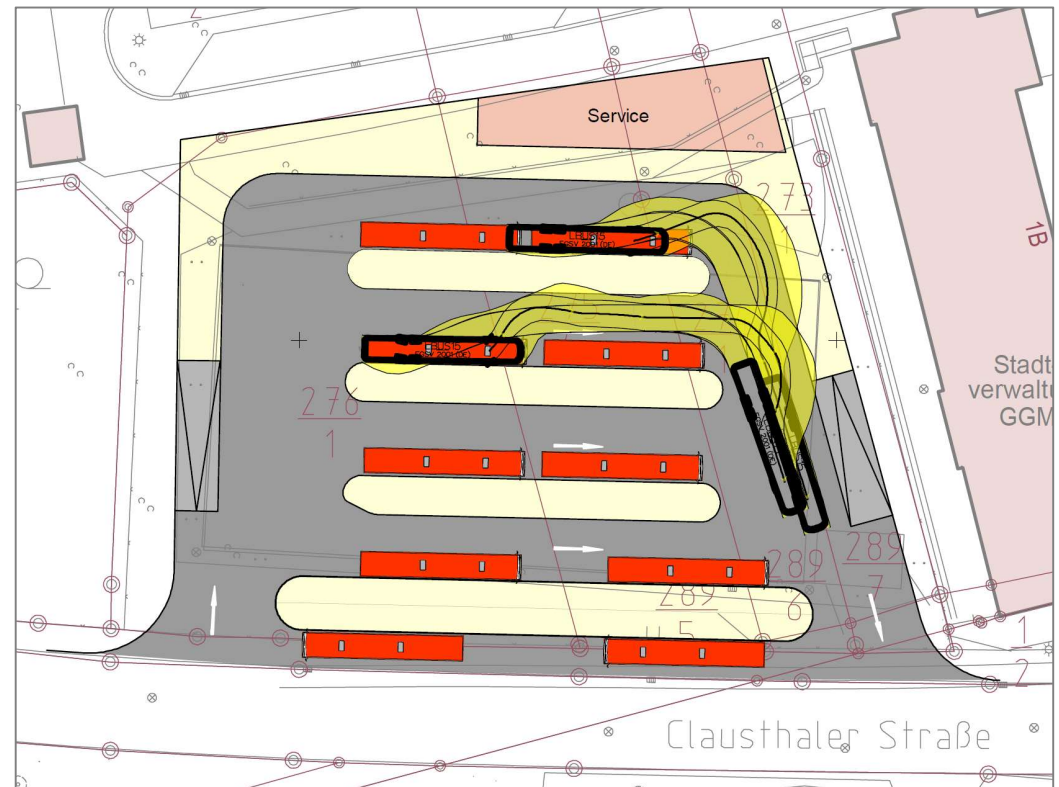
Bauentwurf 1.4 der Busparkpalette Clausthale Straße
